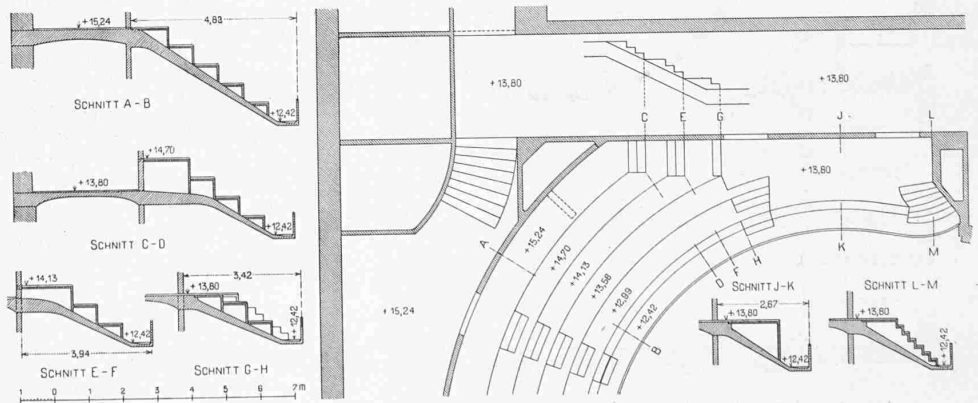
Grundriss und Schnitte des III. Ranges. — Masstab 1 : 200.
